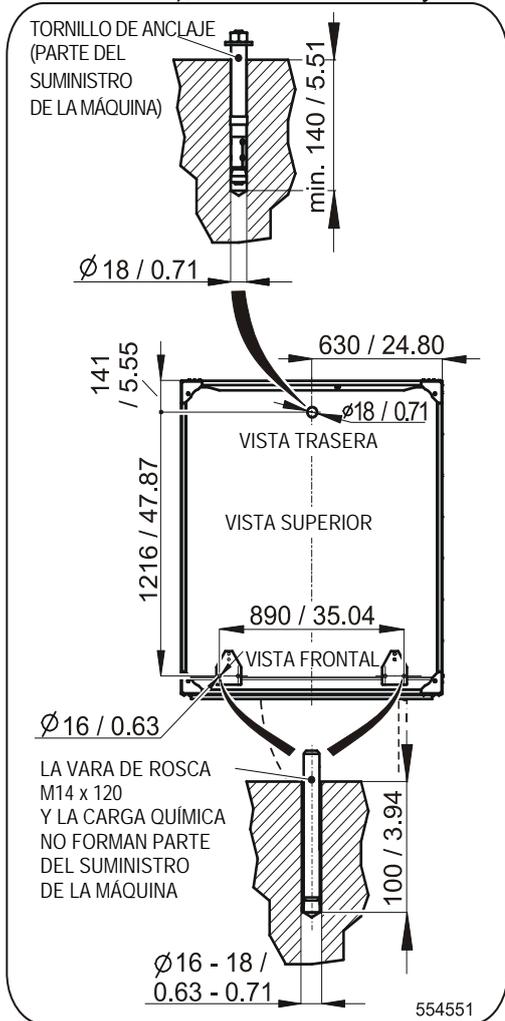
F Máquina 40-55 kg / 90-125 lbs con la inclinación delantera y sin el sistema de pesado - punto del taladrado para el tornillo de anclaje, (dimensiones desde el capó de la máquina en mm / inch)
